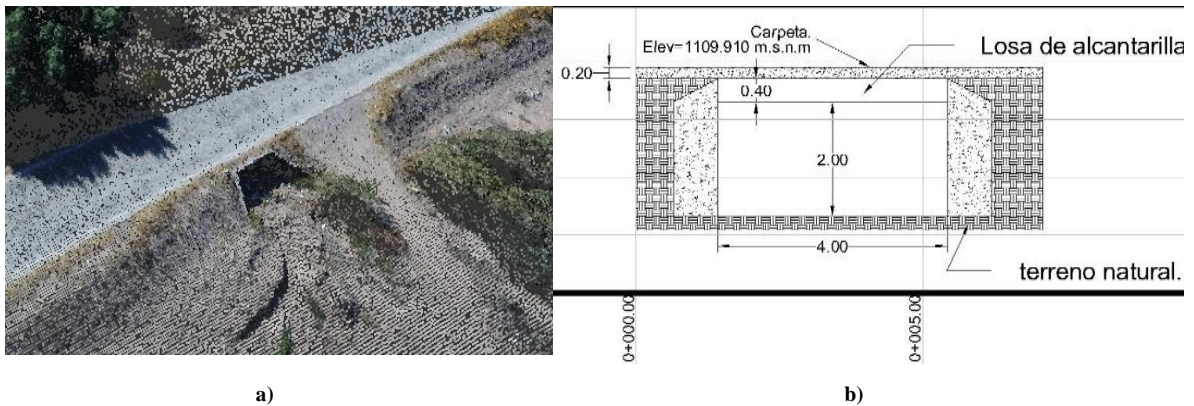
a) Estructura 12 Alcantarilla Y b) Levantamiento de estructura 12 en AutoCAD.
